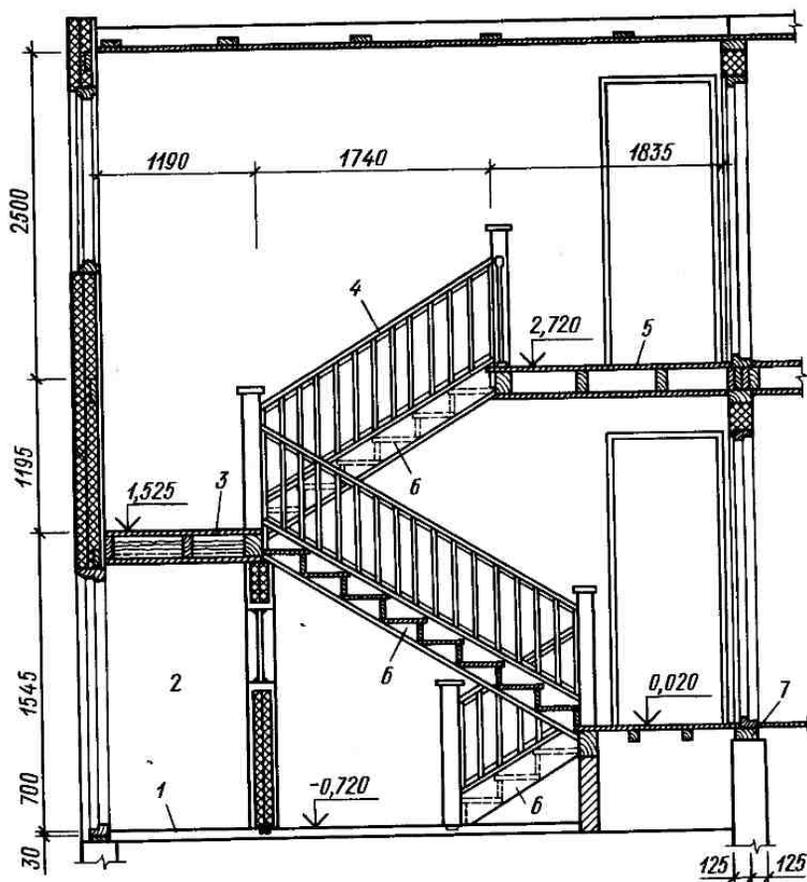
Разрез лестничной клетки каркасного дома:
